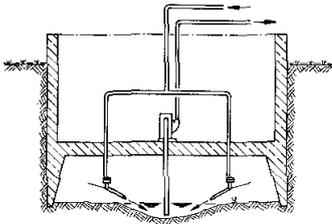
Spülförderung mit Spülkanonen und Dredgerpumpe [2]
